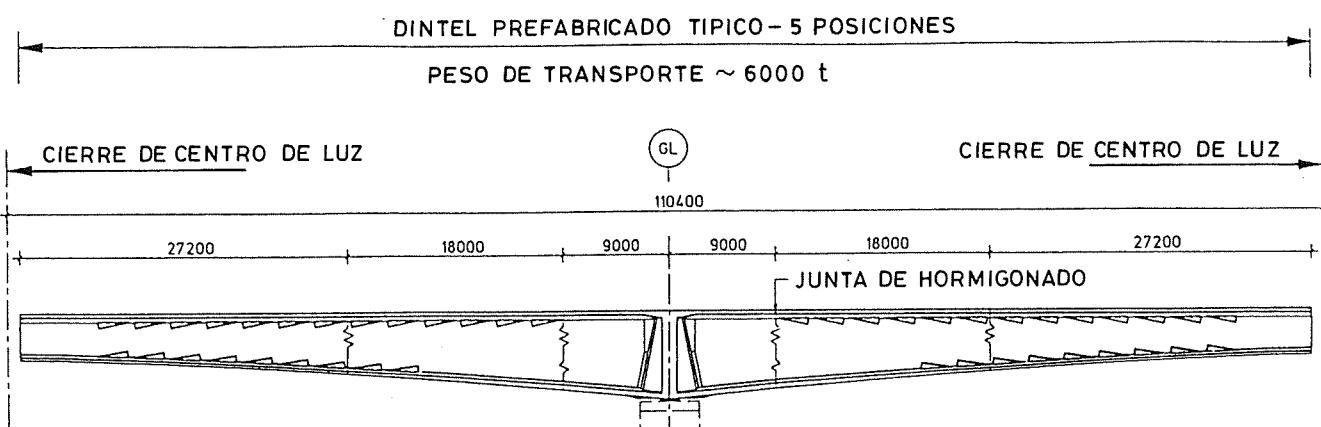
Superestructura prefabricada de hormigón del puente. Sección longitudinal de hormigón.
